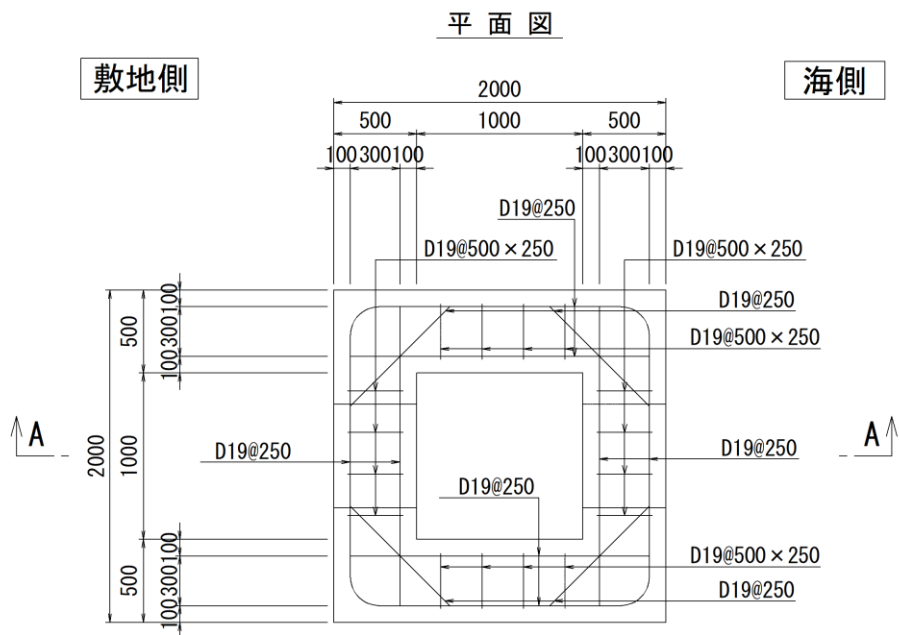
(1) 概略配筋图 (集水枱 (屋外排水路逆止弁⑦)) (单位: mm)
